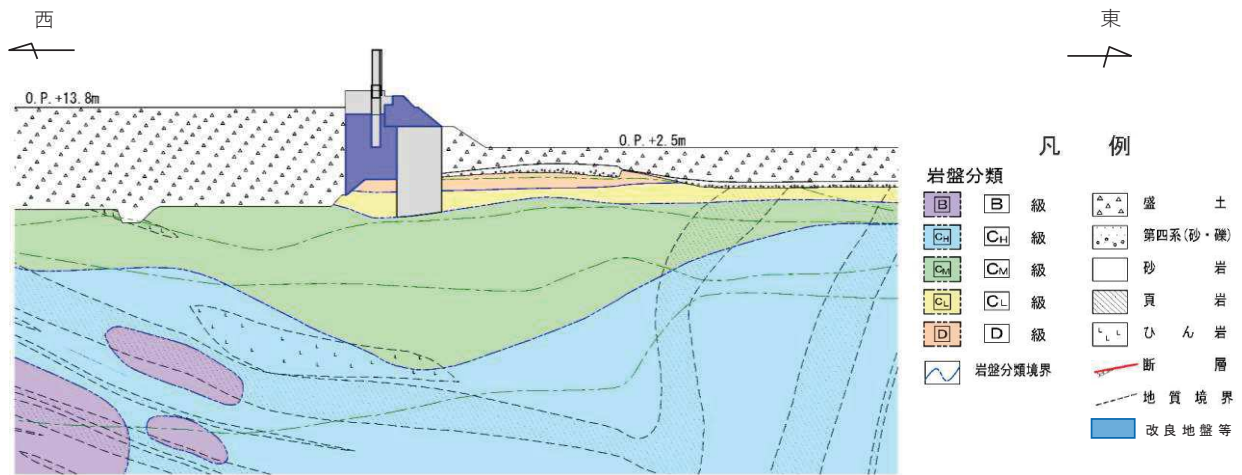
鋼管式鉛直壁（一般部）I-③断面（断面③）
